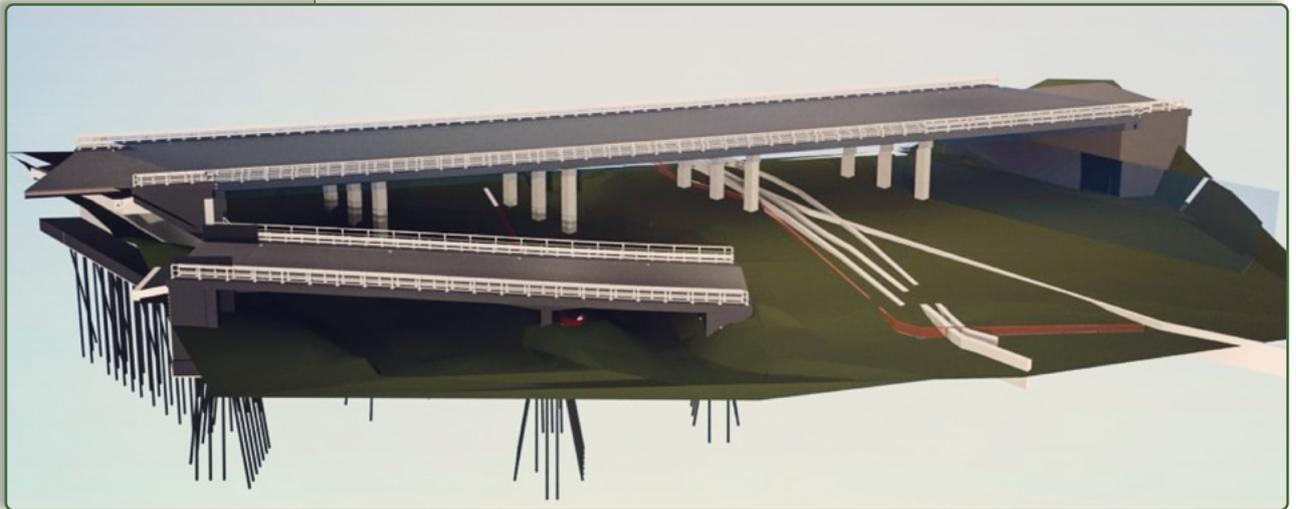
Teilmodell einer Brücke inkl. Rampe mit DGM
